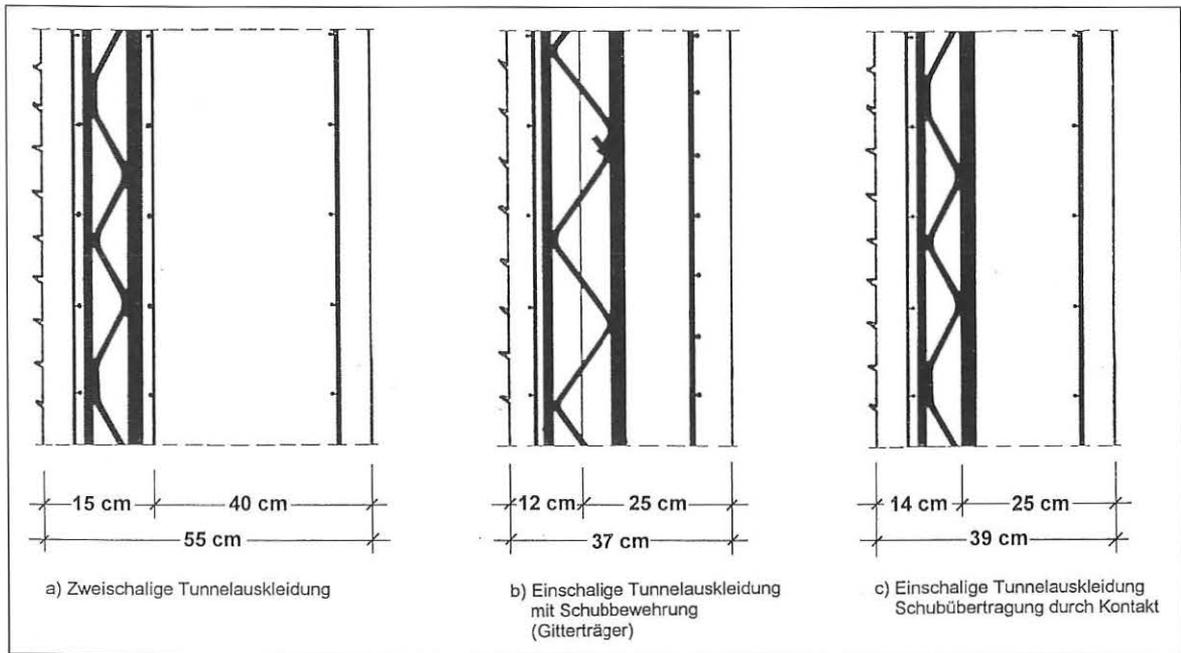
Aufbau und Dicke der zweischaligen und einschaligen Ort beton-Tunnelauskleidungen
